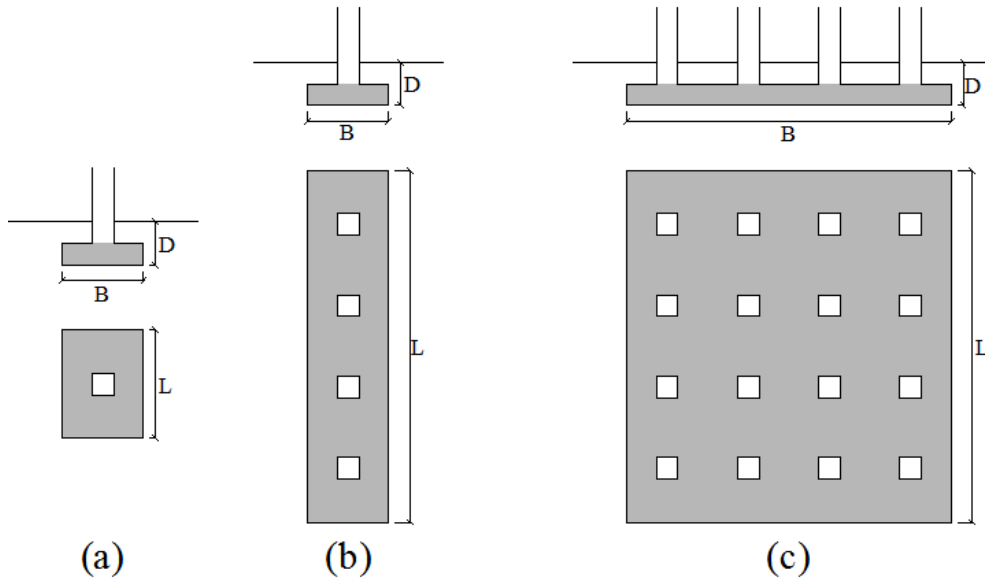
Tipos de fundações superficiais tendo em conta a geometria em planta: (a) sapata isolada; (b) sapata corrida; (c) ensoleiramento geral.
